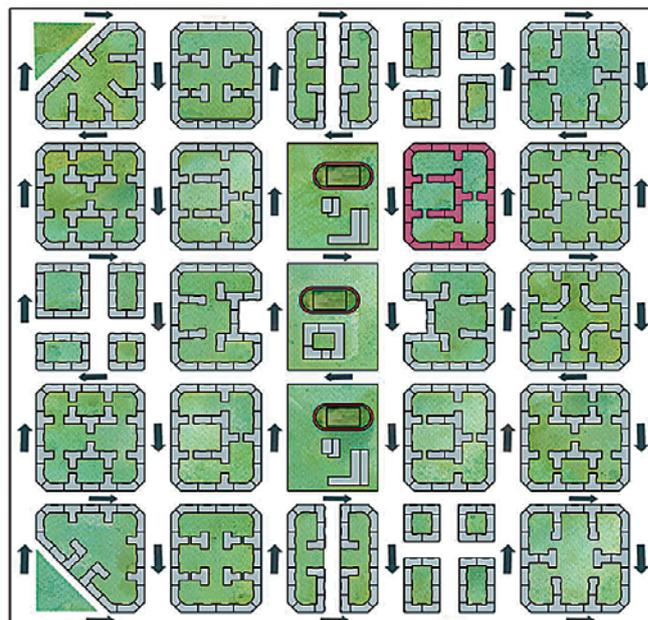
Принципиальная схема жилого комплекса на основе средне-этажной квартальной застройки
